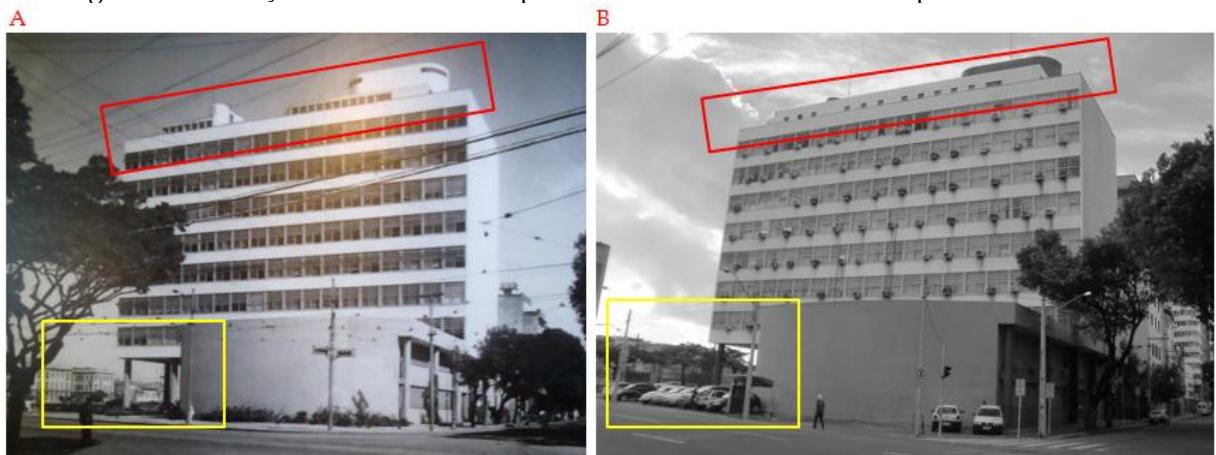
Caixas de ar condicionado inseridas em diversas fachadas
